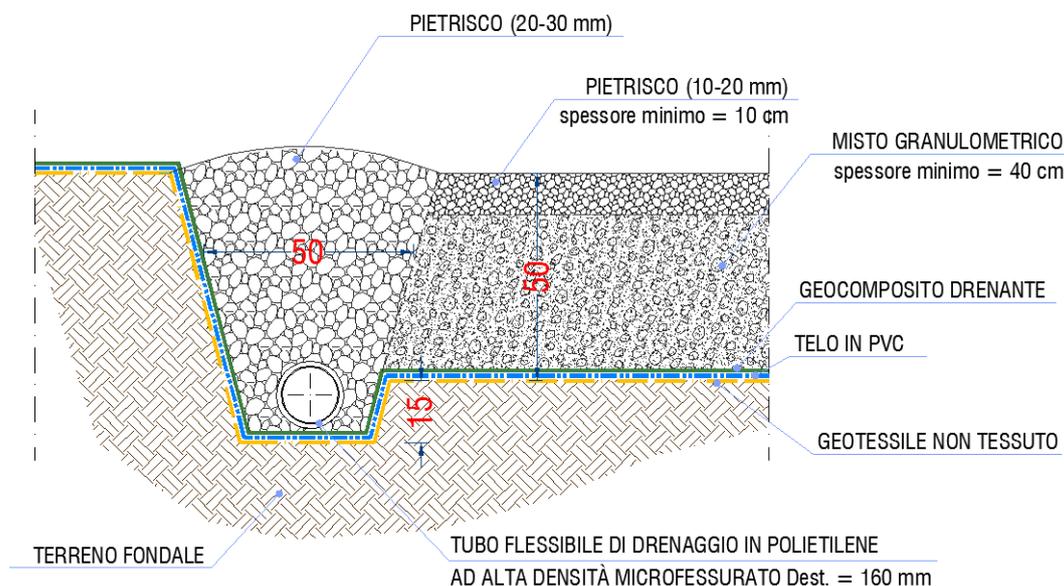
Particolare impermeabilizzazione e canale di scolo
